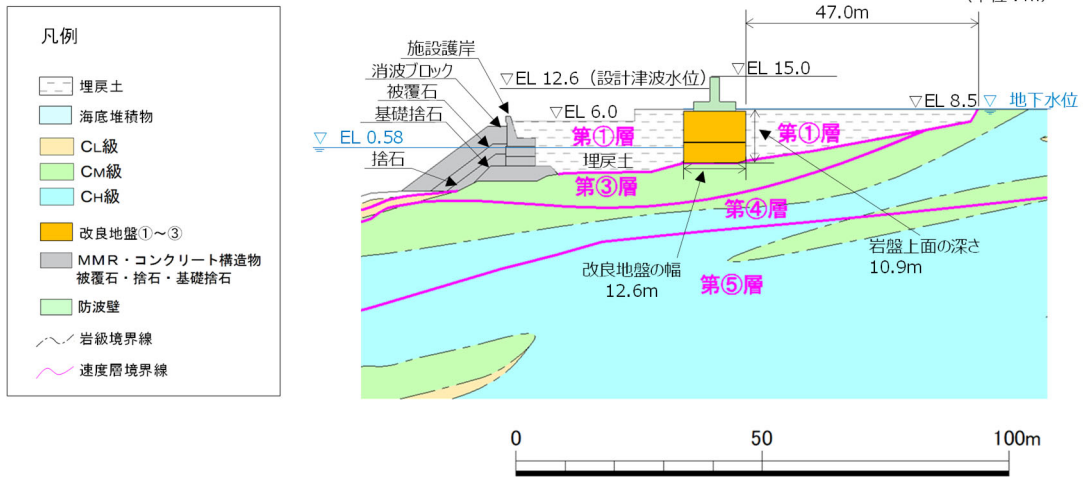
防波壁（逆T擁壁）の横断面図（①-①断面）
